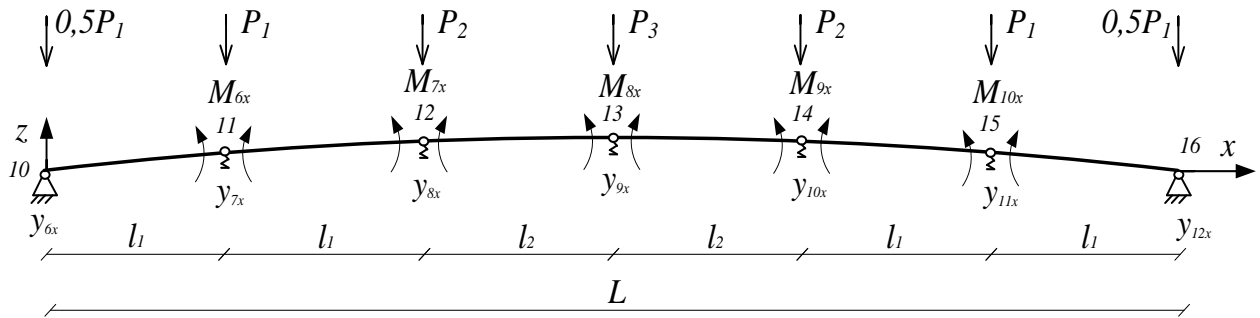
Розрахункова схема залізобетонної поперечно напруженої балки
